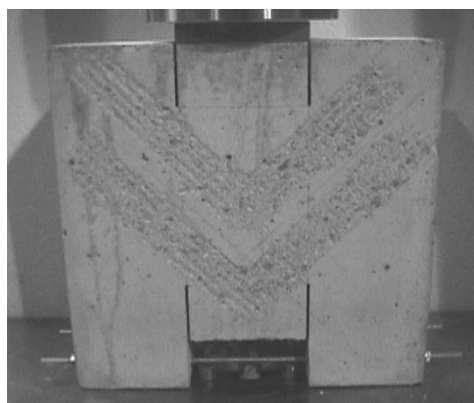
Las entallas realizadas en las probetas ayudan a guiar la trayectoria de las fisuras a cortante
